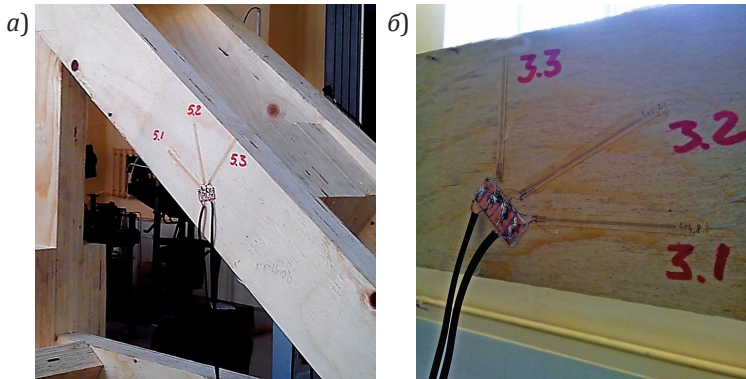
Установка розеток тензодатчиков: а – на раскосах фермы; б – на нижнем поясе фермы
